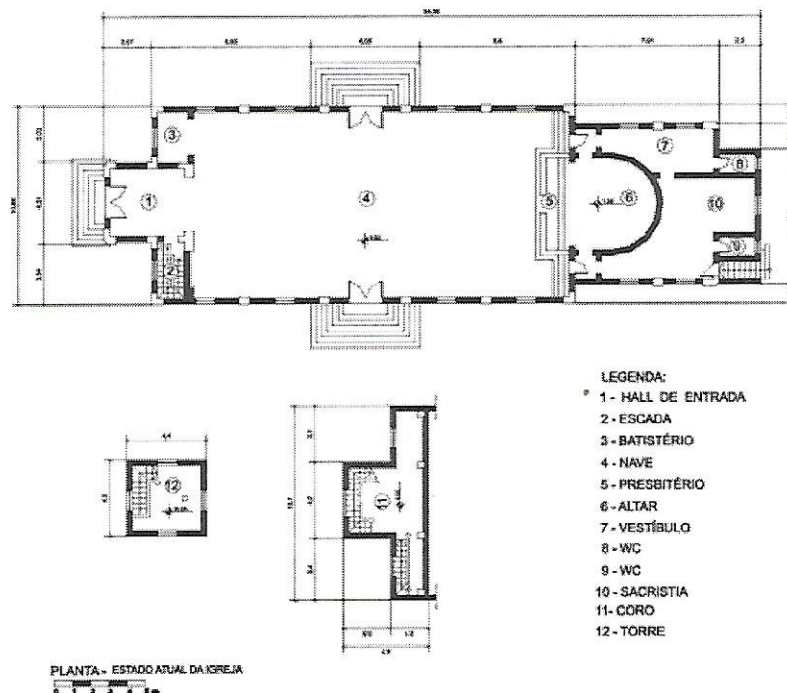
Planta da Igreja Nossa Senhora das Dores. FONTE: SALCEDO, et al., 2004.
